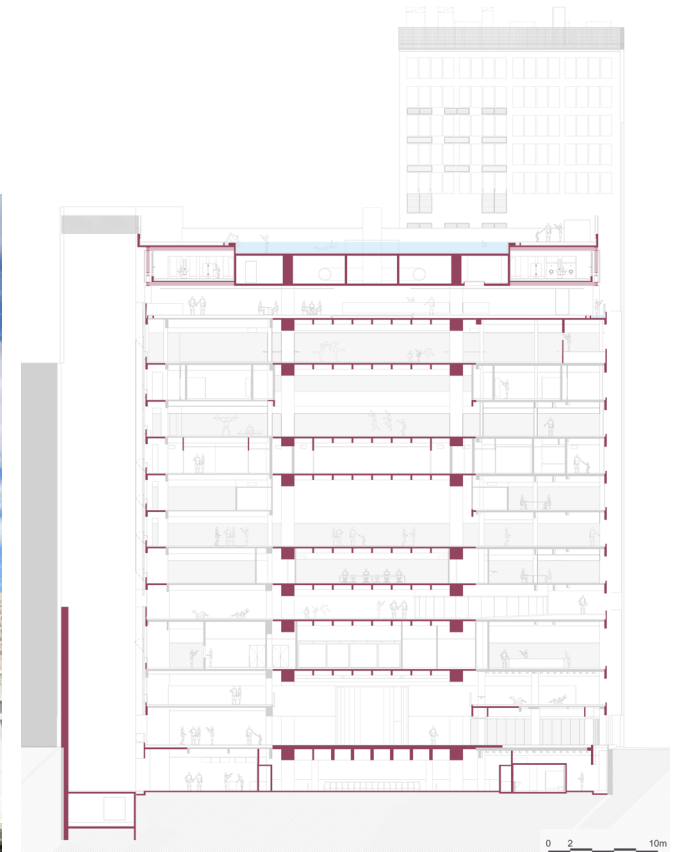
Sección con indicación en rojo de todas las intervenciones estructurales realizadas en el Sec 24 de Maio. (Autoría propia, 2022).
